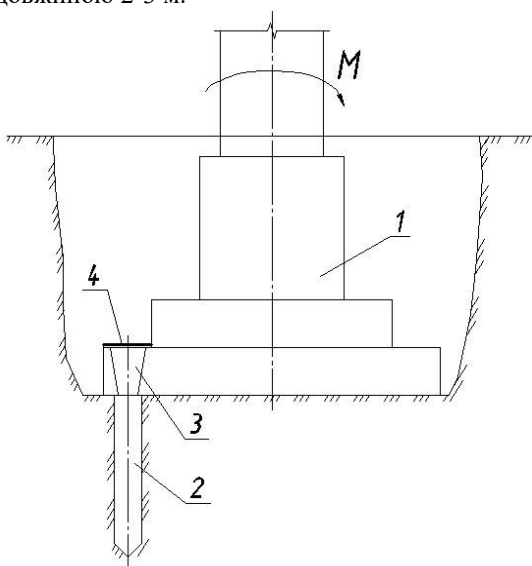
Посилення стовпчастого фундаменту анкерами при дії значного моментного навантаження: 1 – посилюваний фундамент; 2 – анкери з буронабивних армованих палі, що працюють на висмикування;
